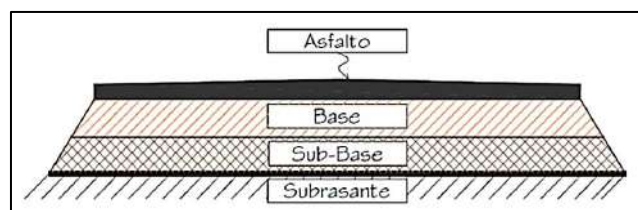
Sección transversal típica de pavimento flexible Armijos [42]
